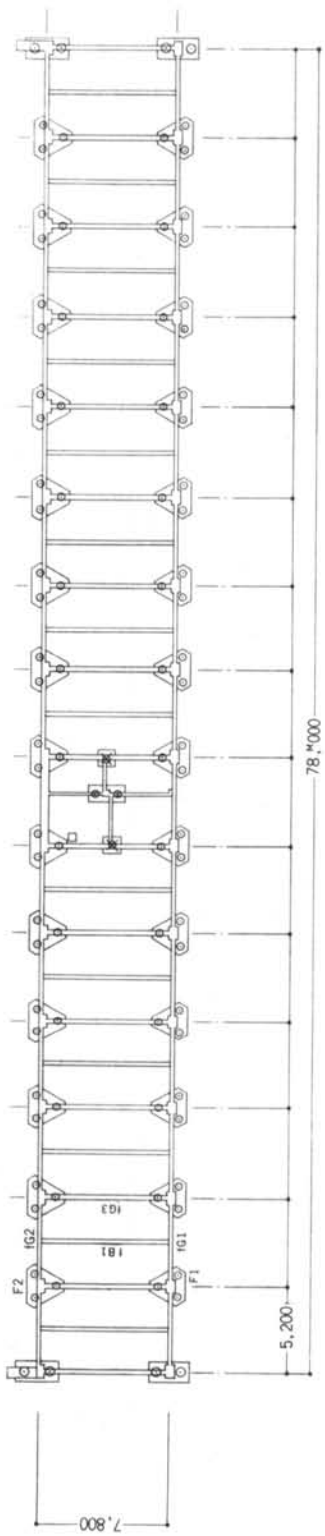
平面図 (2階~10階) 注)エレベーターは1.4.6.8.10階にのみ停止
